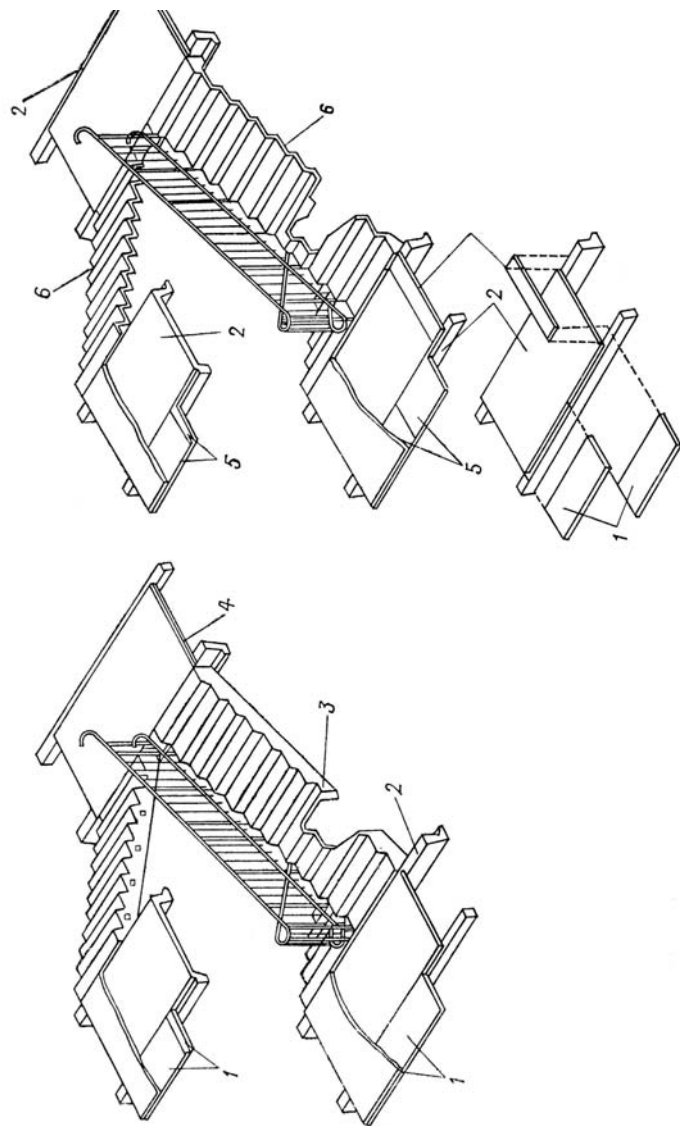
Сборные железобетонные лестничные марши и площадки: 1 – доборные плиты; 2 – лестничная площадка; 3 – марш складчатый двухкосоурный; 4 – площадка промежуточная; 5 – плита; 6 – марш складчатый однокосоурный
